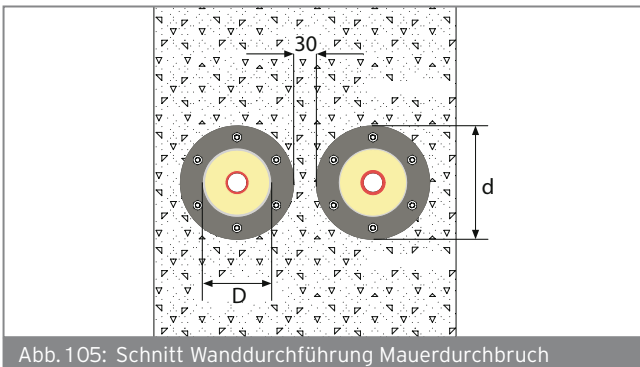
Schnitt Wanddurchführung Mauerdurchbruch
